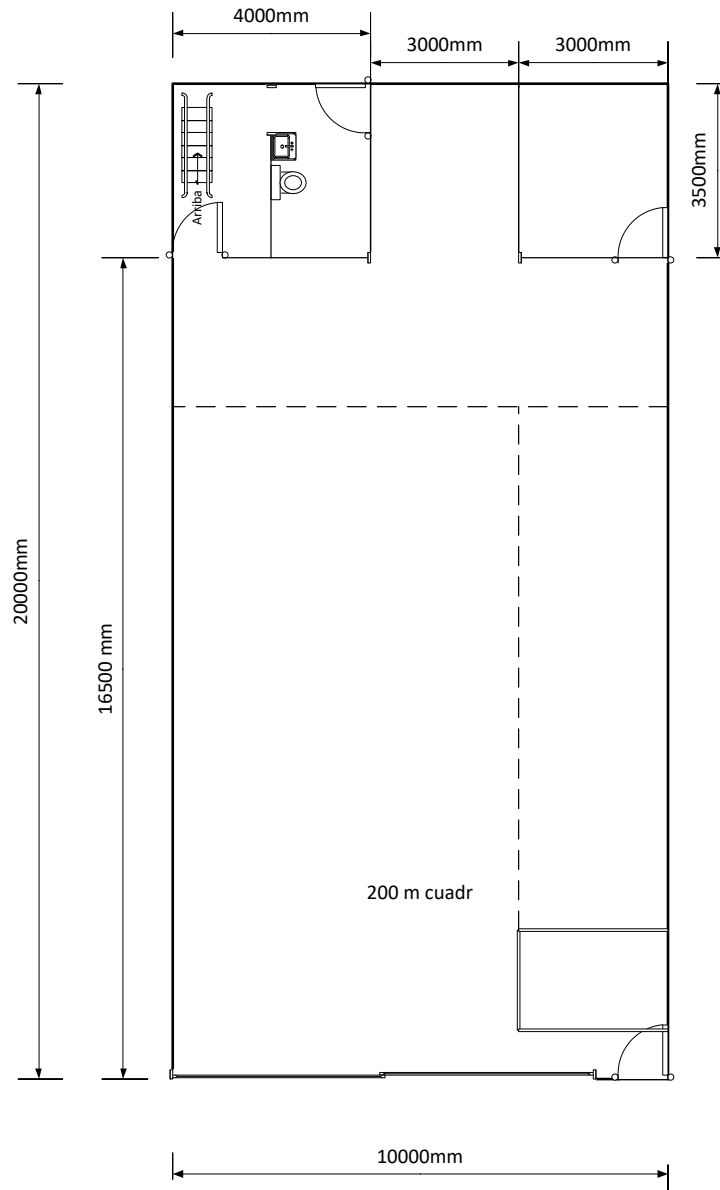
Layout de la nueva planta de manufactura objeto de estudio, planta baja
